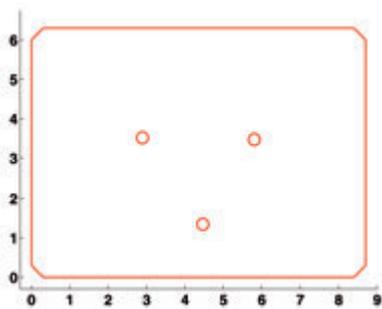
Grundriss der Zeltdachkonstruktion
